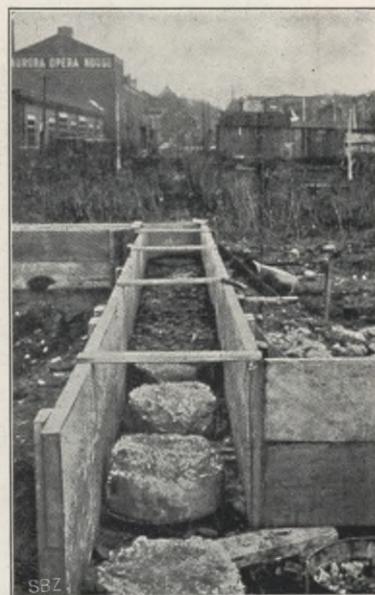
Betonpfahlköpfe in den Mauerfundamenten.
